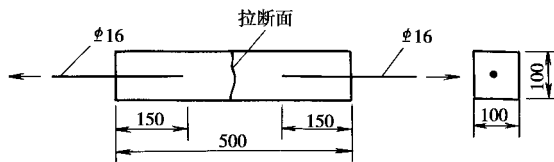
混凝土轴心抗拉强度试验(尺寸单位: mm)
